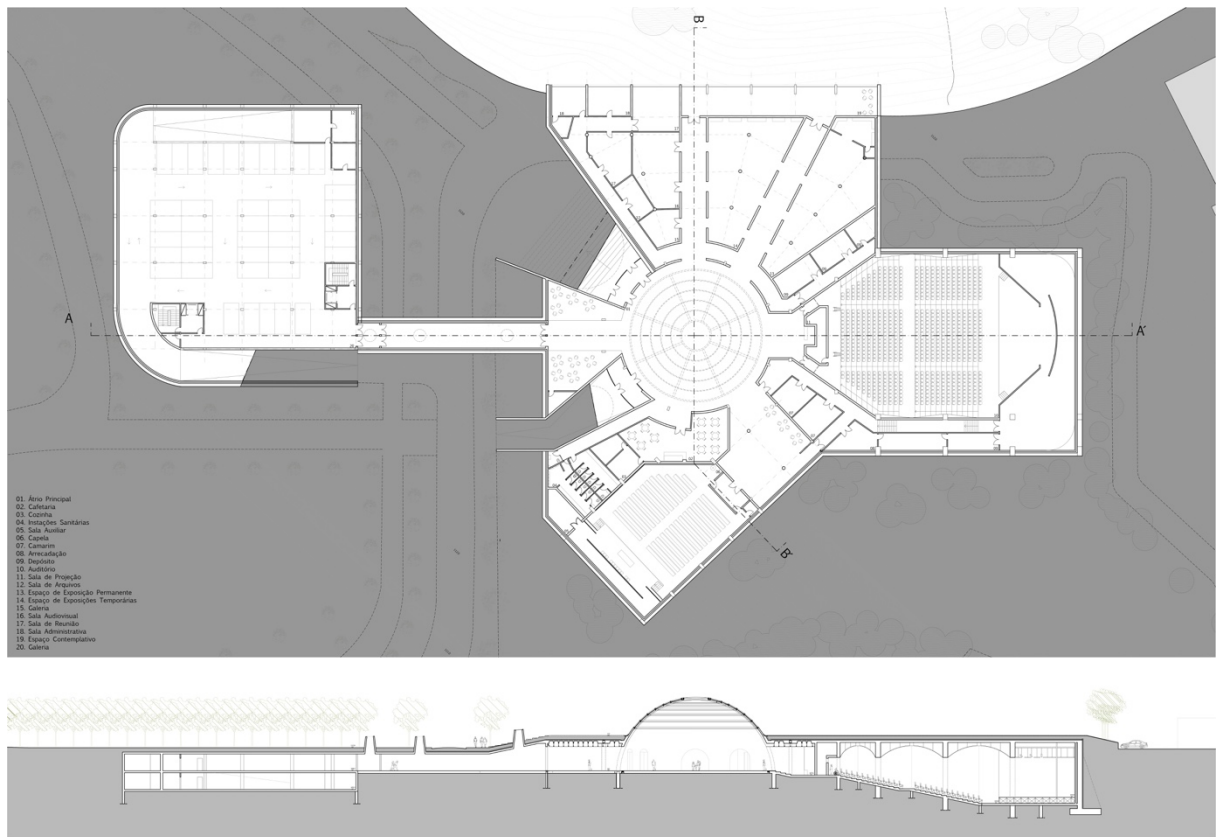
Proposta do Núcleo Museológico (Planta e Corte Longitudinal [AA']).
